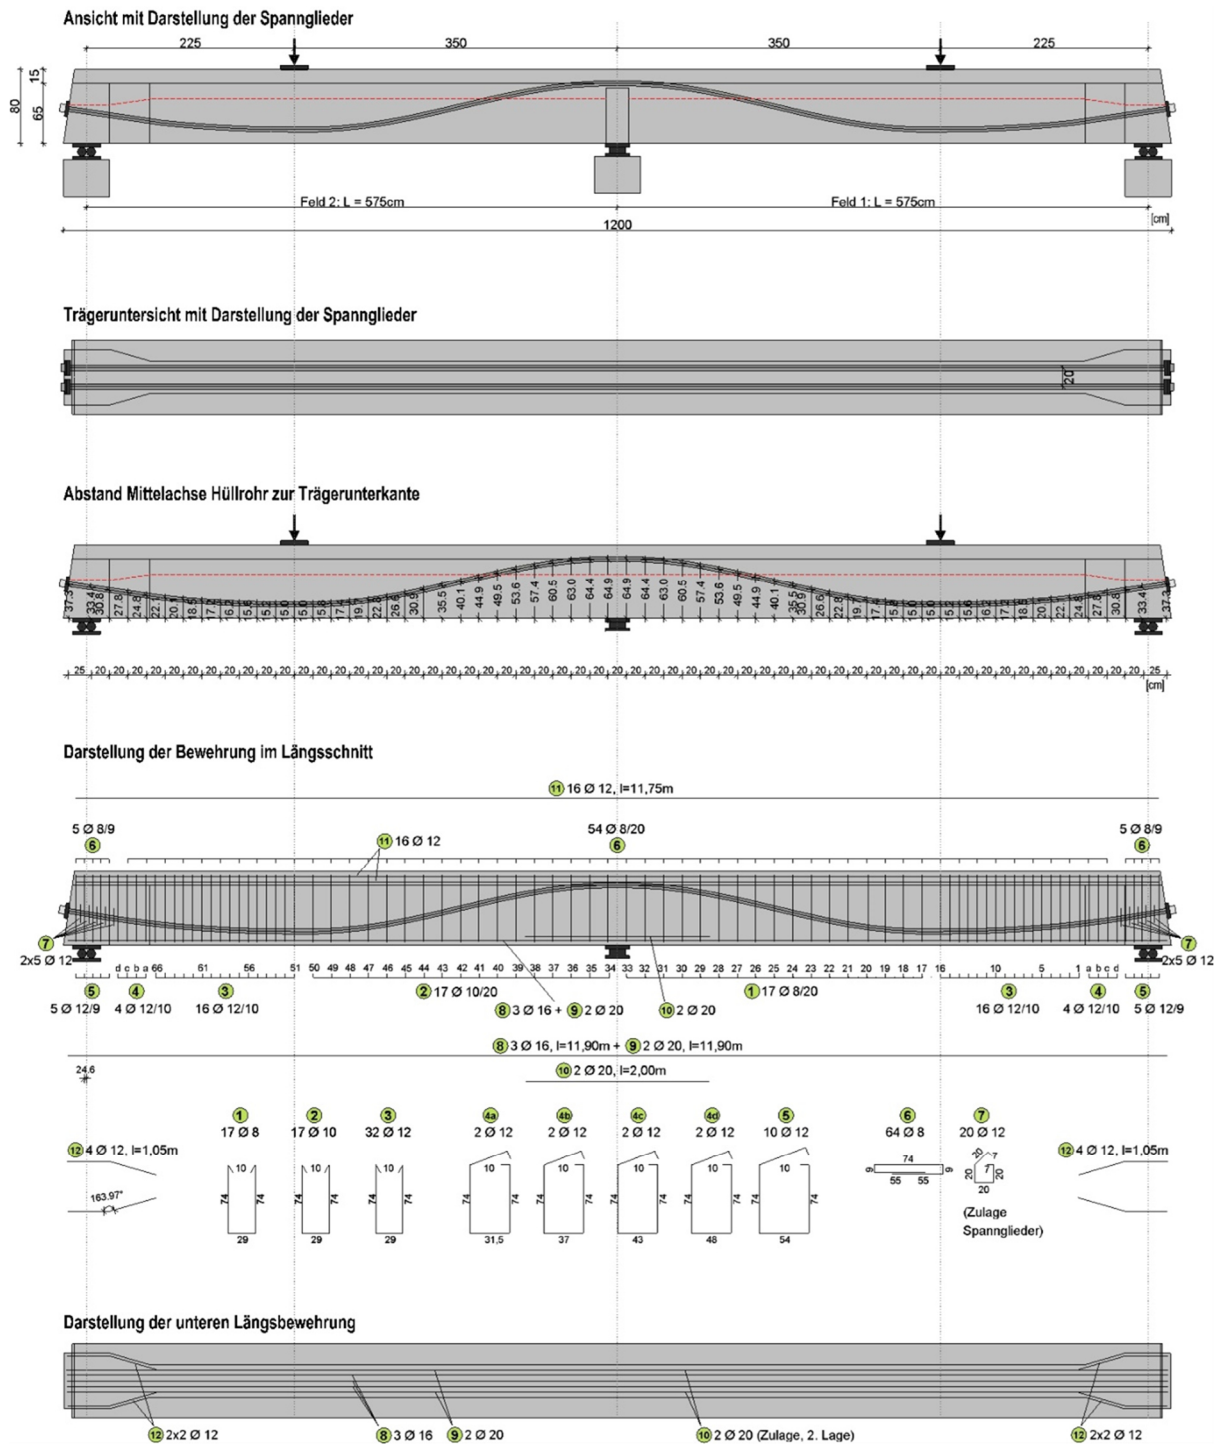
Bewehrungsplan Versuchsträger DLT 6
